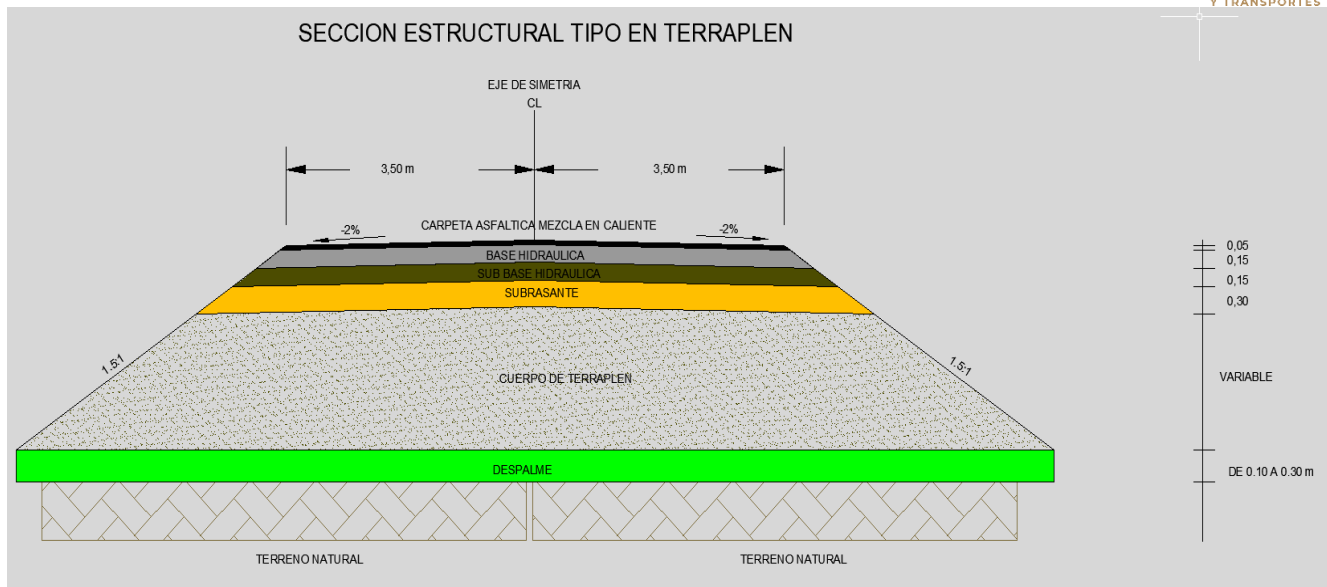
Sección estructural Uso de suelo y vegetación en la zona del proyecto.
